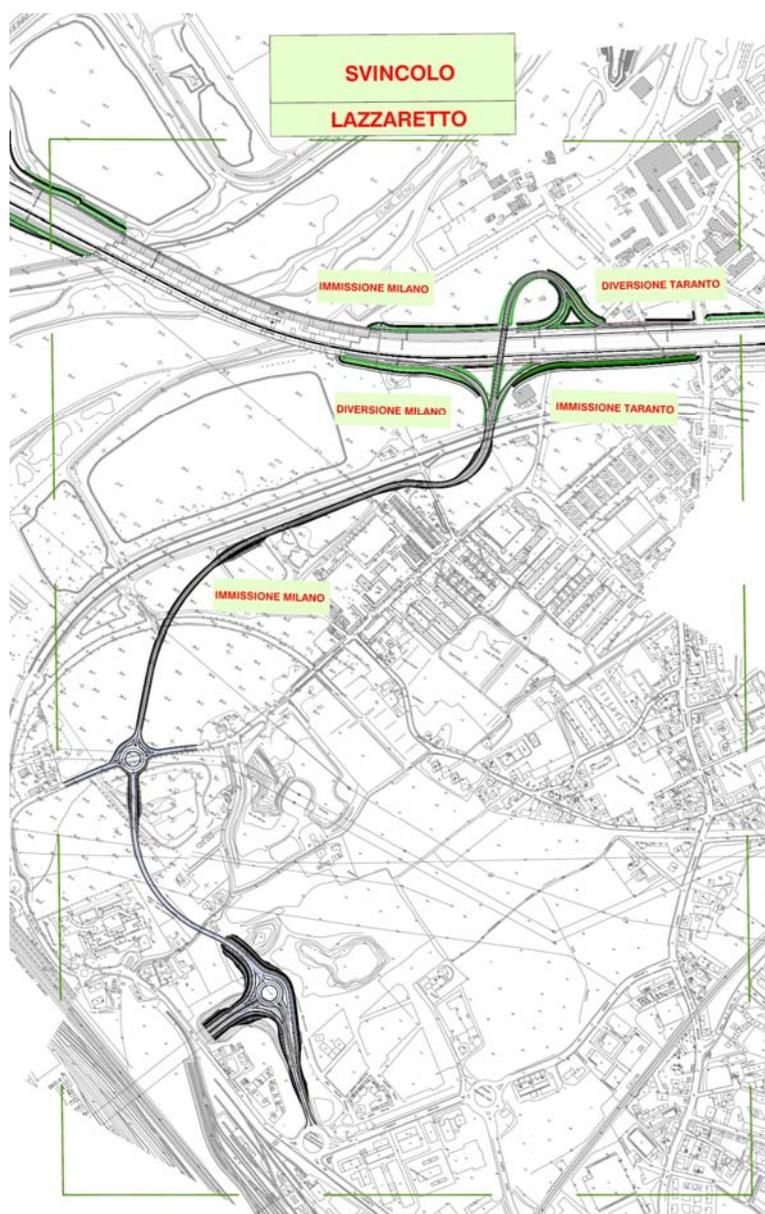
Stralcio planimetrico svincolo di Lazzaretto
